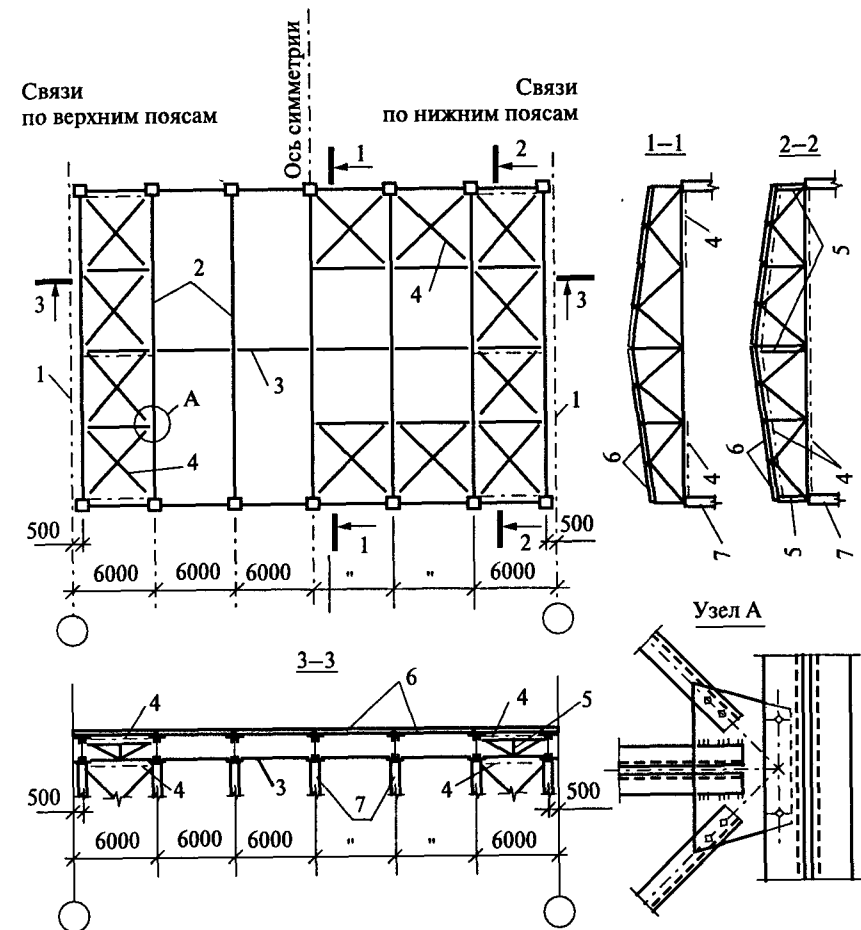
Связи покрытия при железобетонных кровельных плитах:
